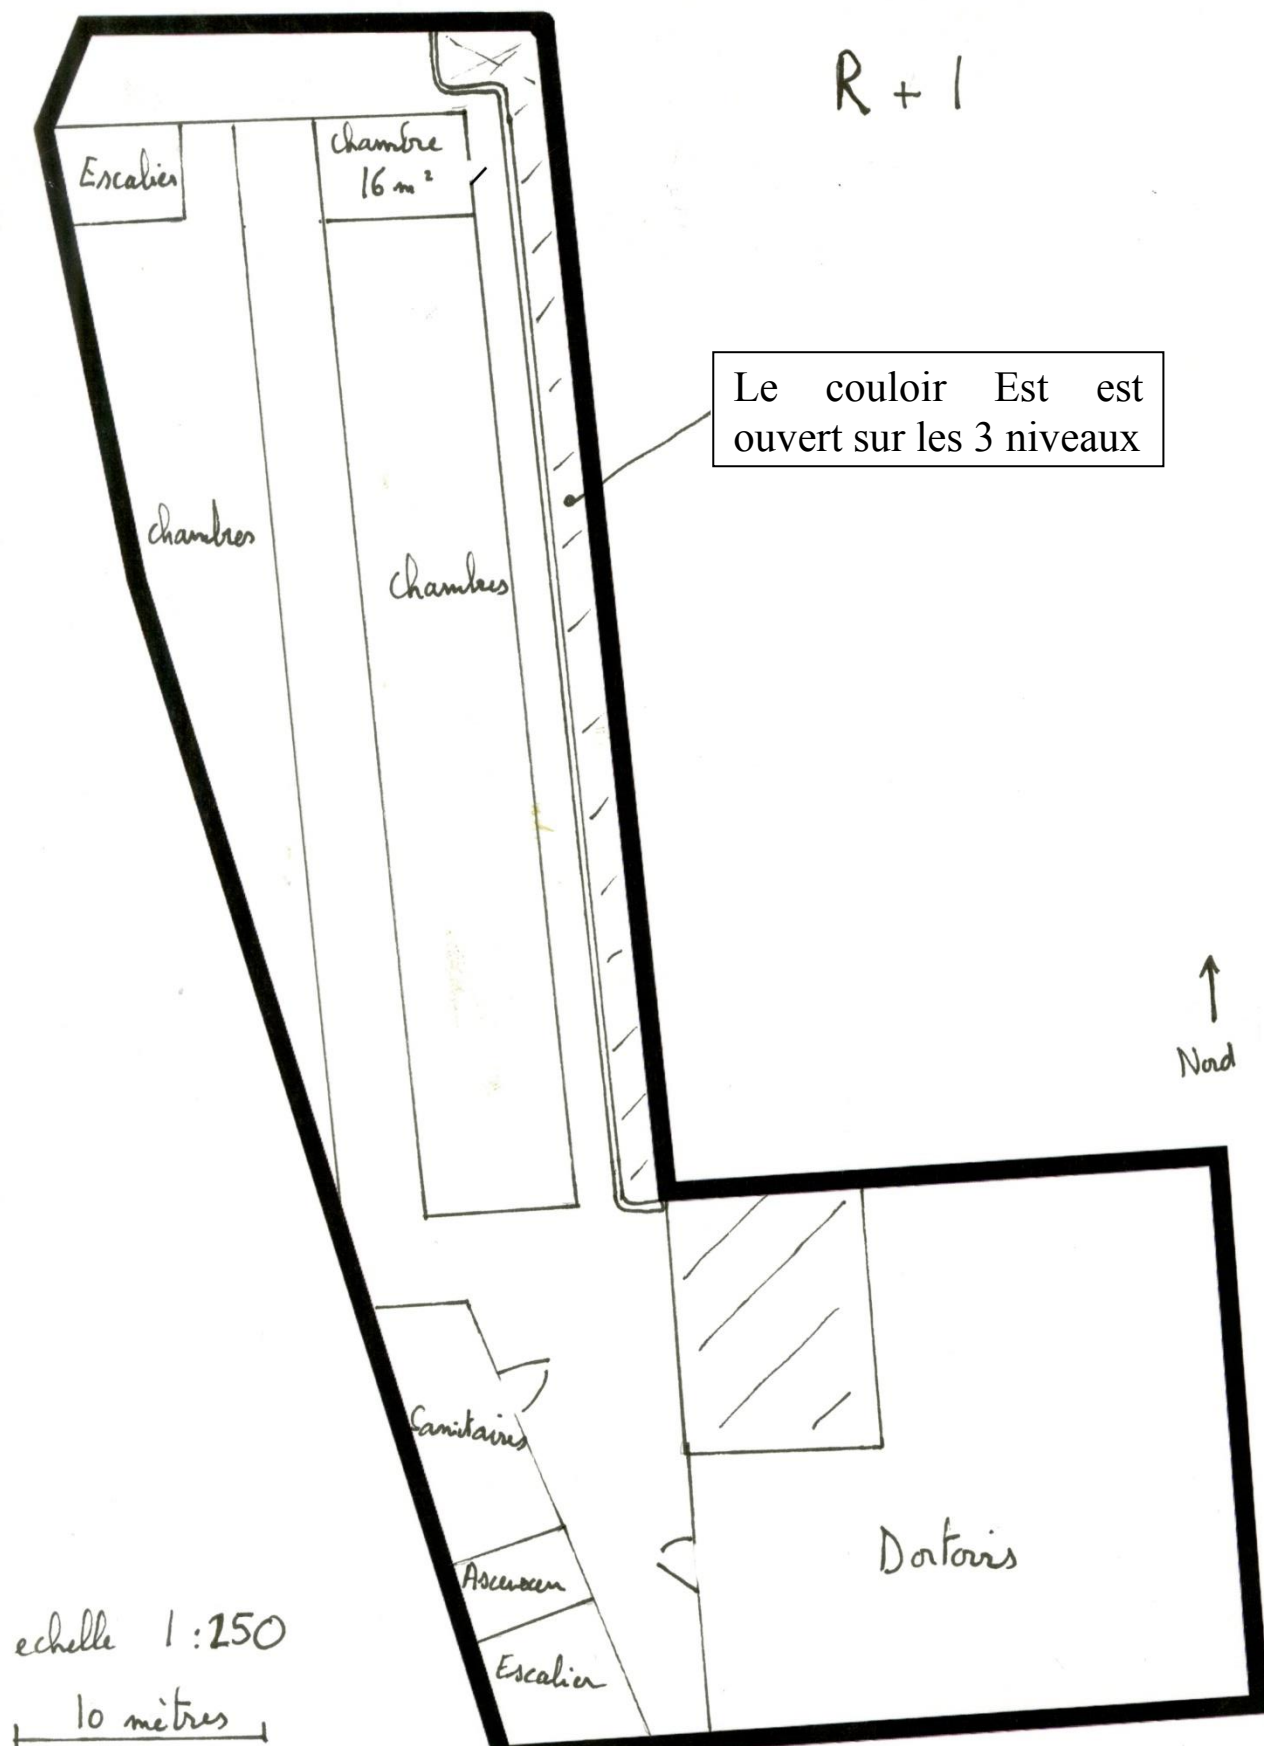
Plan d'ensemble du R+1 (Haouy)
